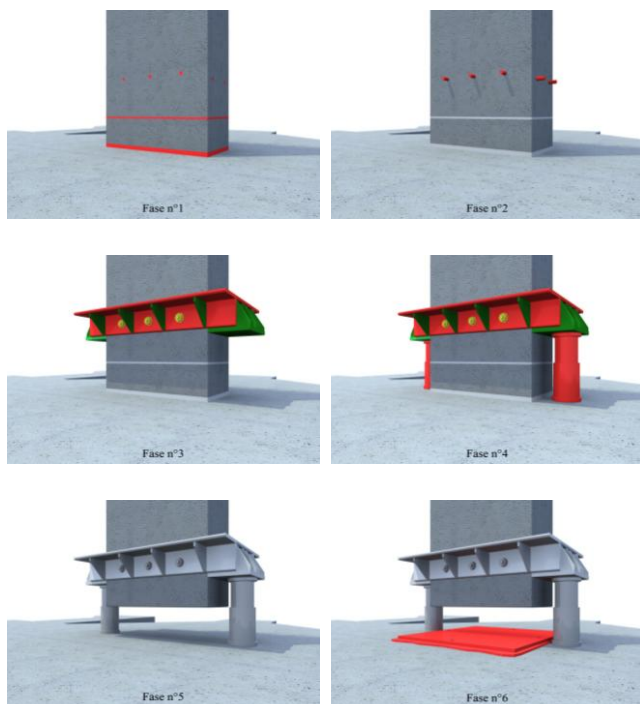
Fasi preliminari all'inserimento di un isolatore al di sotto di un pilastro esistente.
